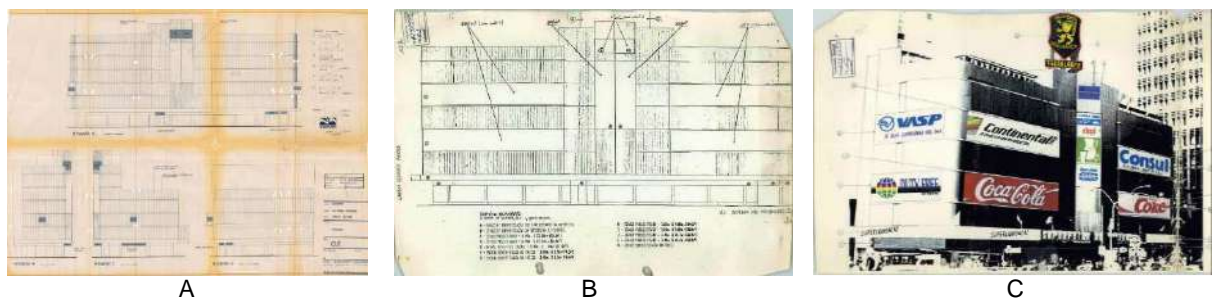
A: Projeto original, fachadas da proposta para revestimento da fachada conforme executado – 1988.
